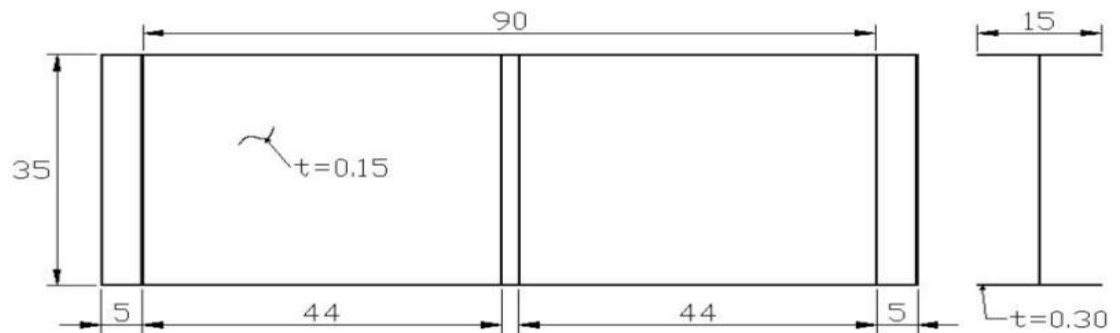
Plano en centímetros de la primera configuración de viga I
